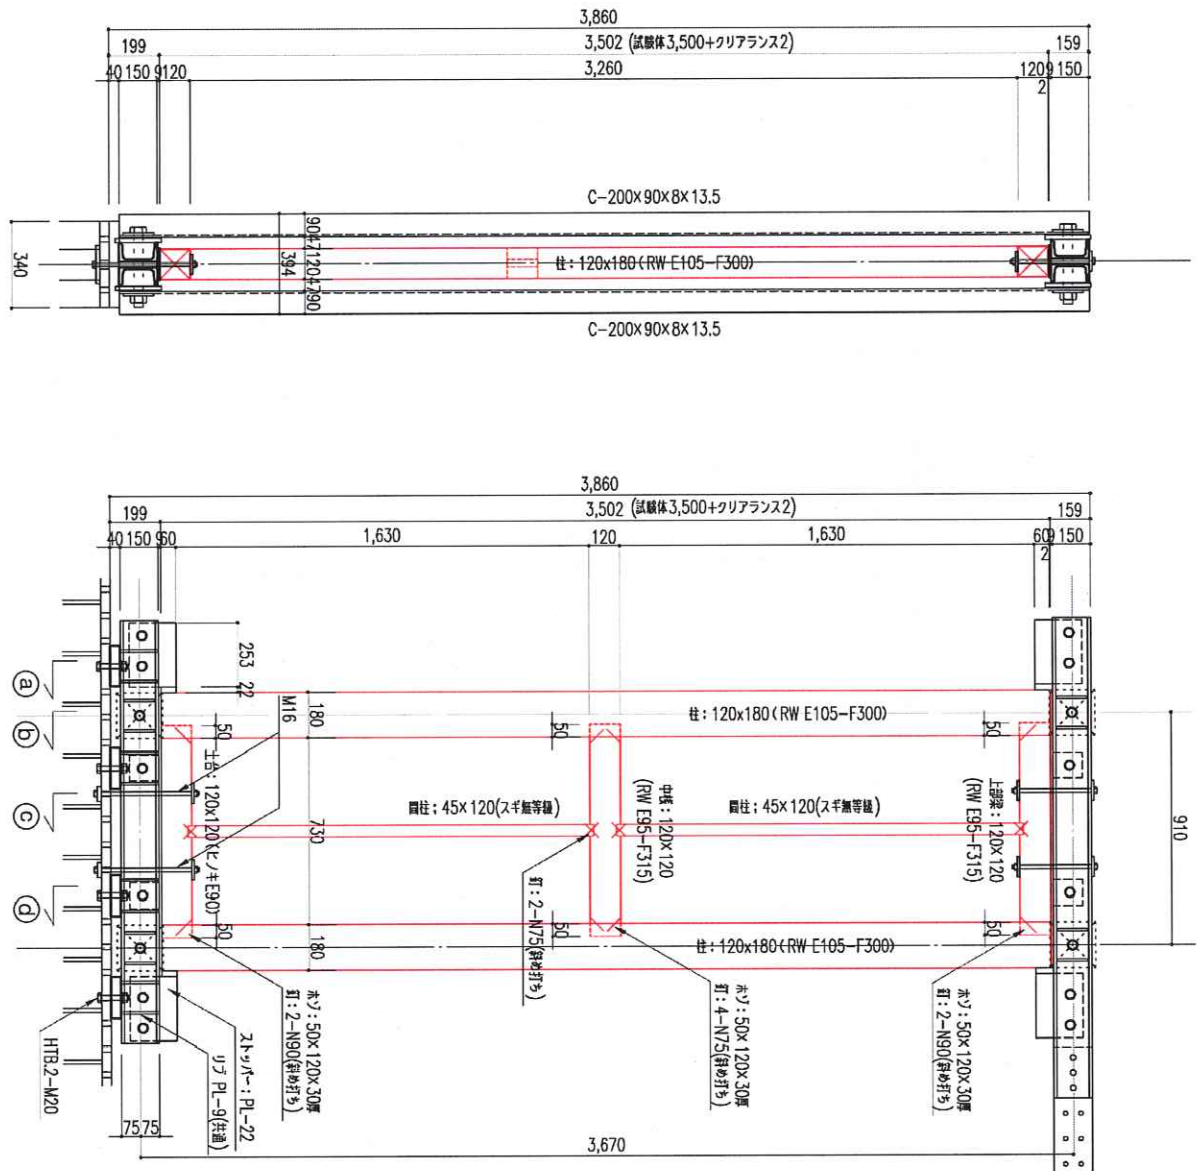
試験法 B 試験体図 (木軸) (単位: mm)
